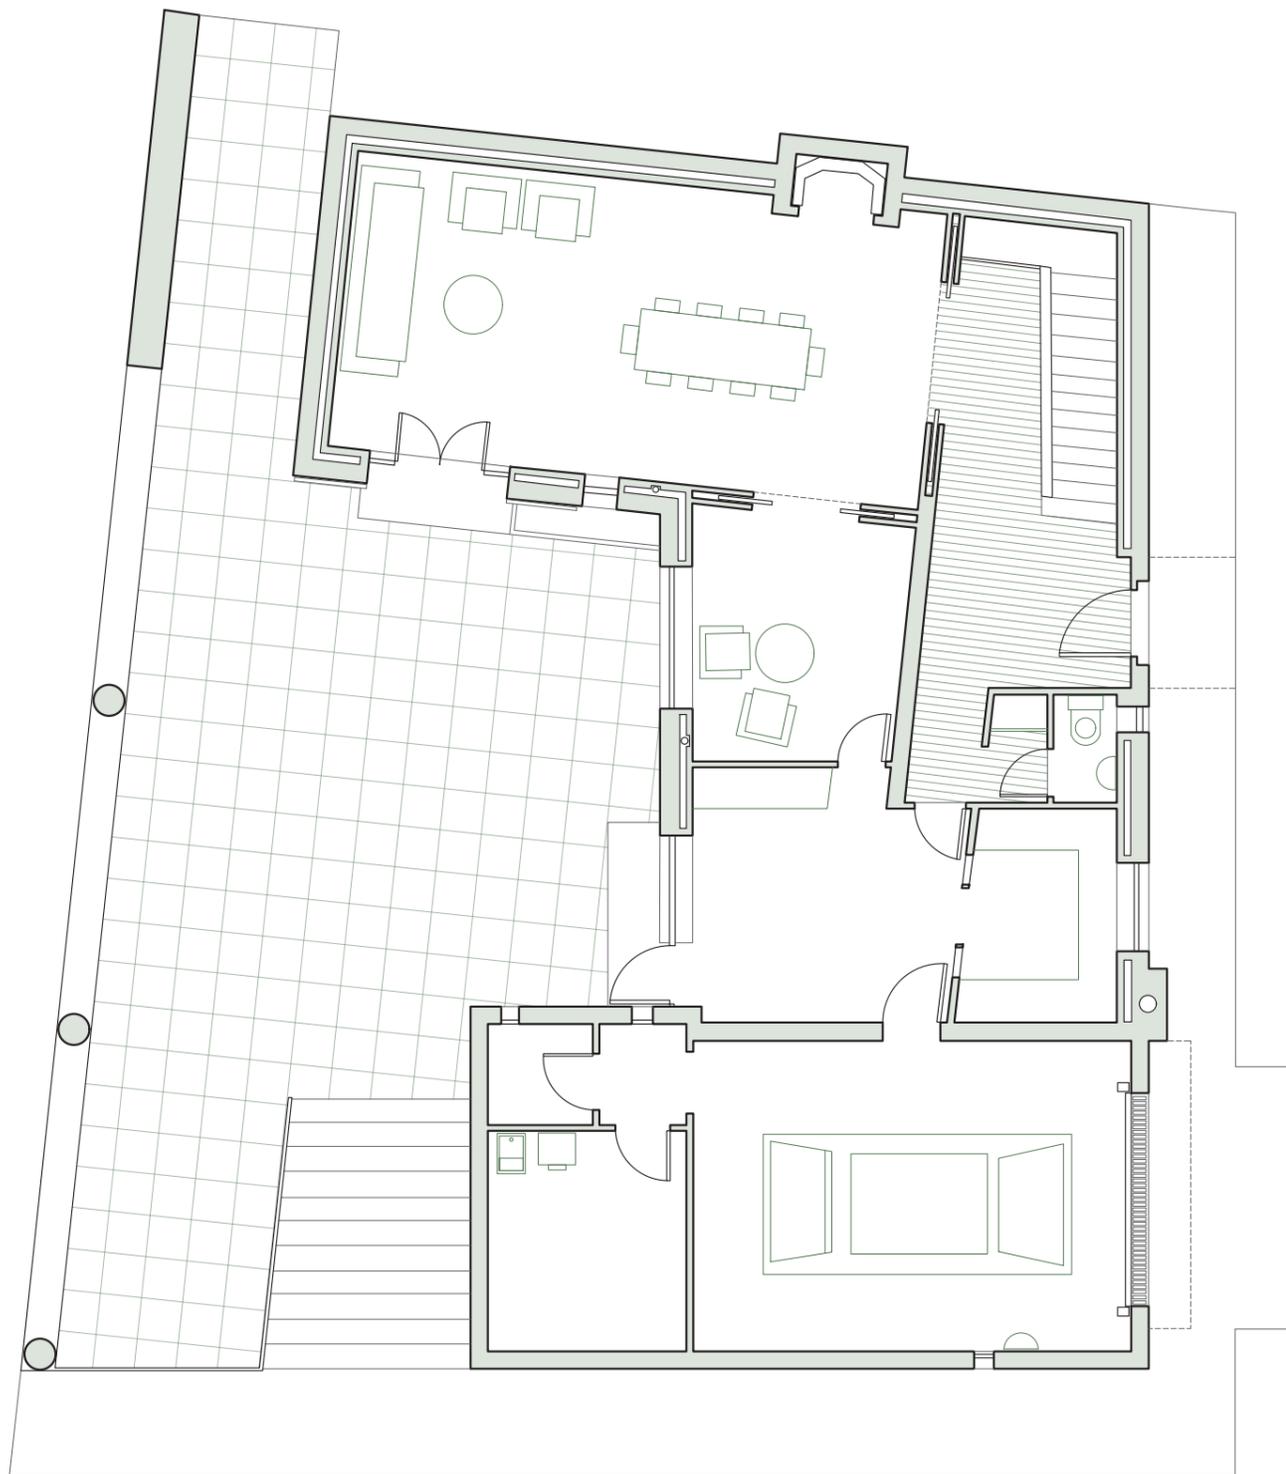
Planta baja. Casa Cerdá. Escala 1:100
